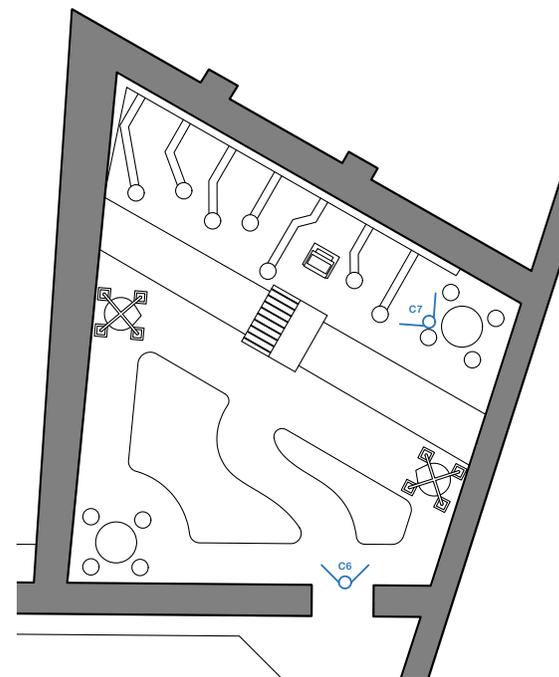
Planta Propuesta Zona de Exhibición - Historia (B2)
